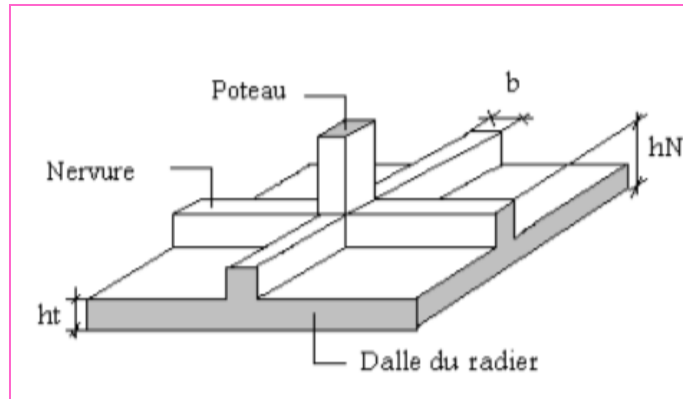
Disposition des nervures par rapport au radier et aux poteaux
